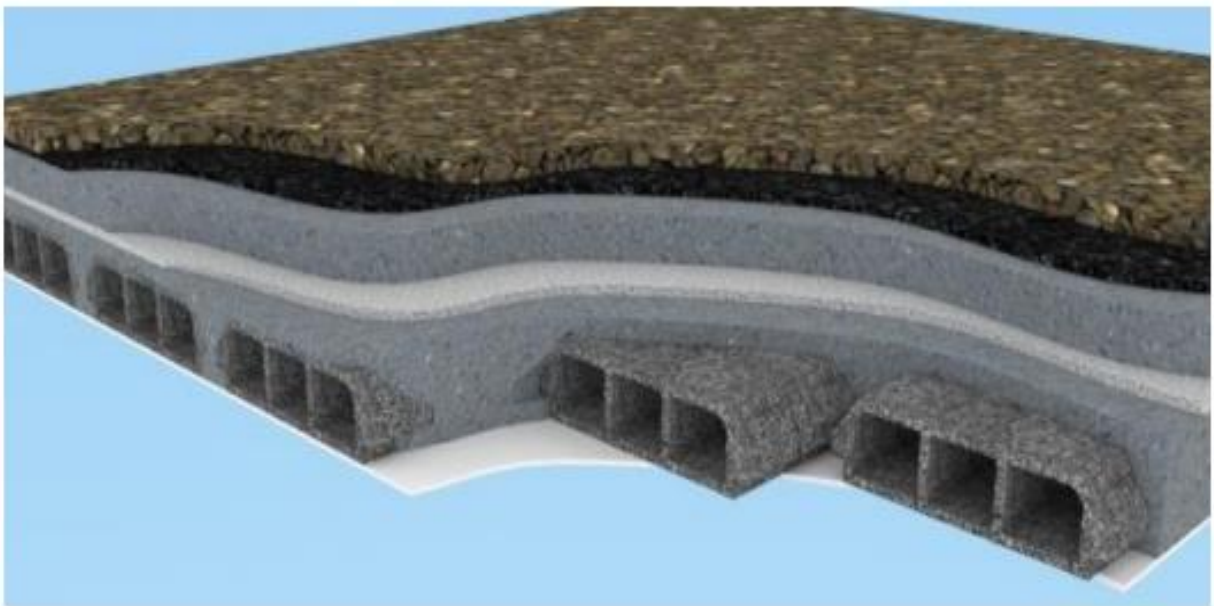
Coupe 3D Du Plancher Terrasse Inaccessible
